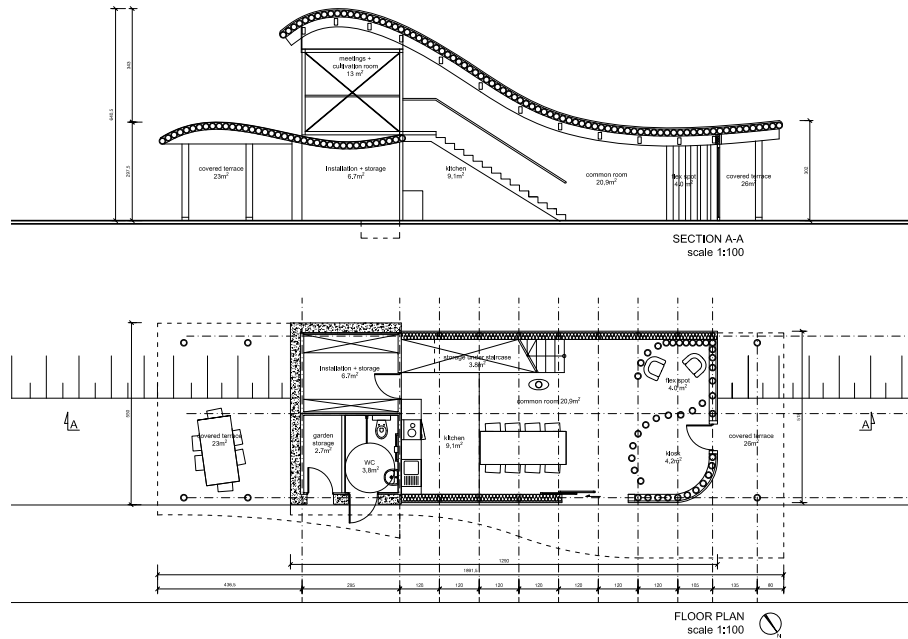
Bij(e)nkorf, section and floor plan, 2017
